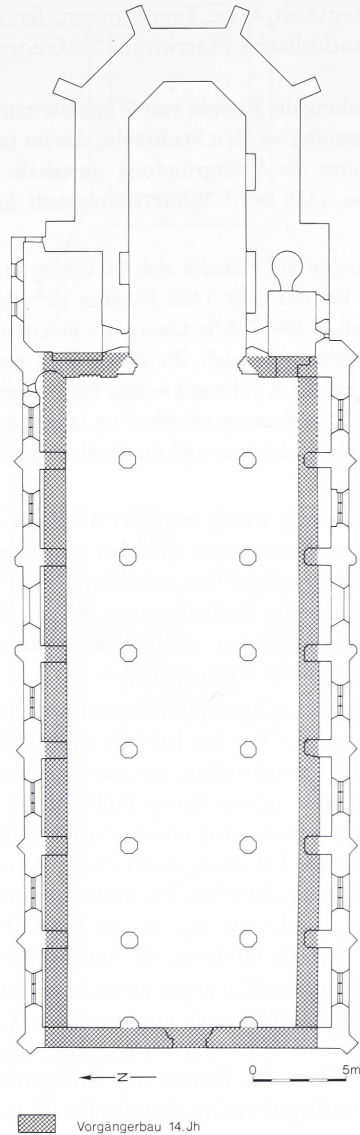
Balingen, Zollernalbkreis. Grundriß der Stadtkirche mit archäologischem Befund.
